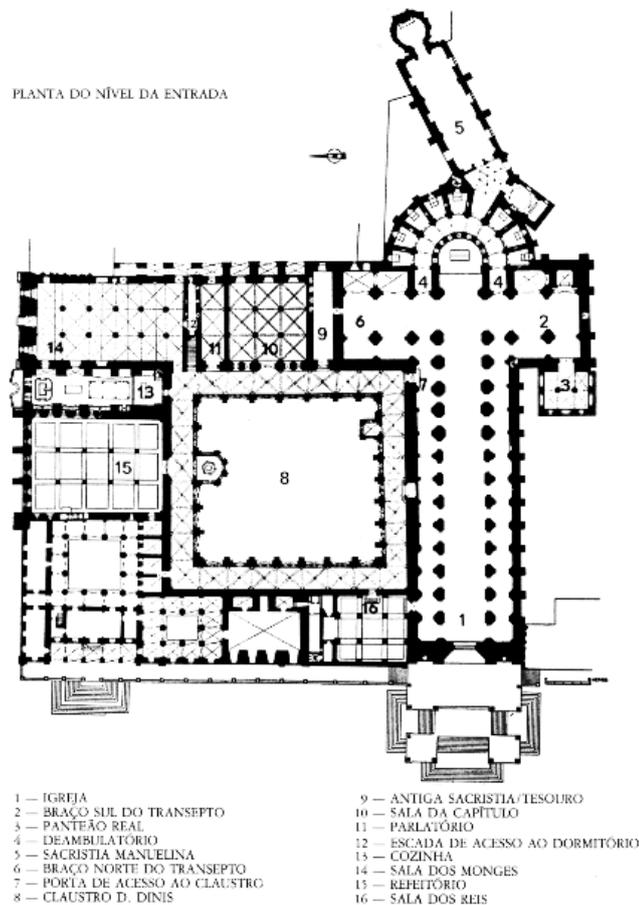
Planta do Mosteiro Gótico de Santa Maria de Alcobaça, no séc.XIV
